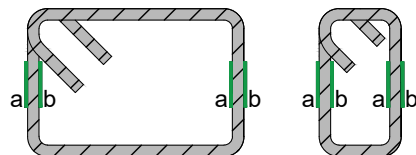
Detalhe do posicionamento dos pares de extensômetros nos estribos [mm]
